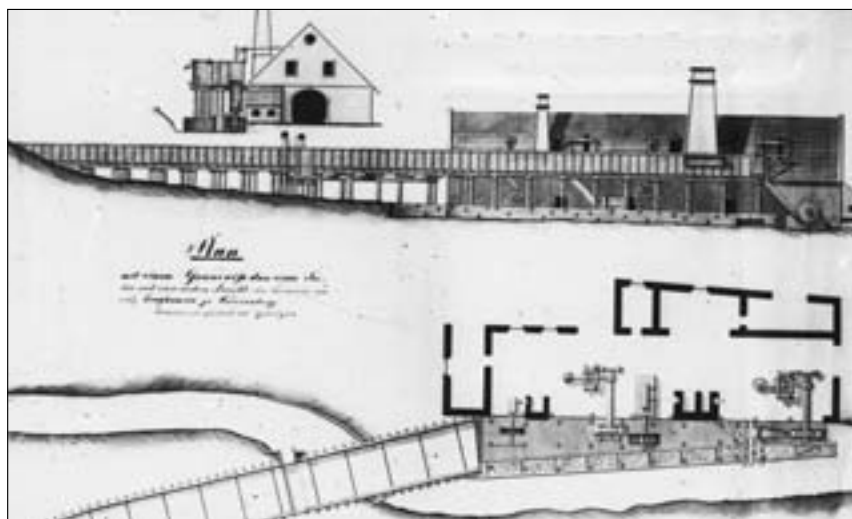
„Plan mit einem Grundriss, dann einer Seiten- und einer vorderen Ansicht des Radmeister-communitätlichen Zeughammers in Vordernberg“, 1834.
